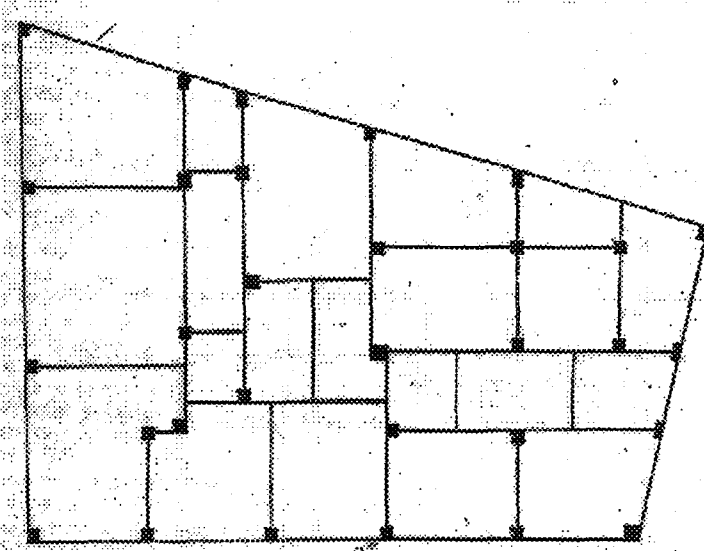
Banco Central de America Binası Tipik Kat Planı. [29, s 64]
